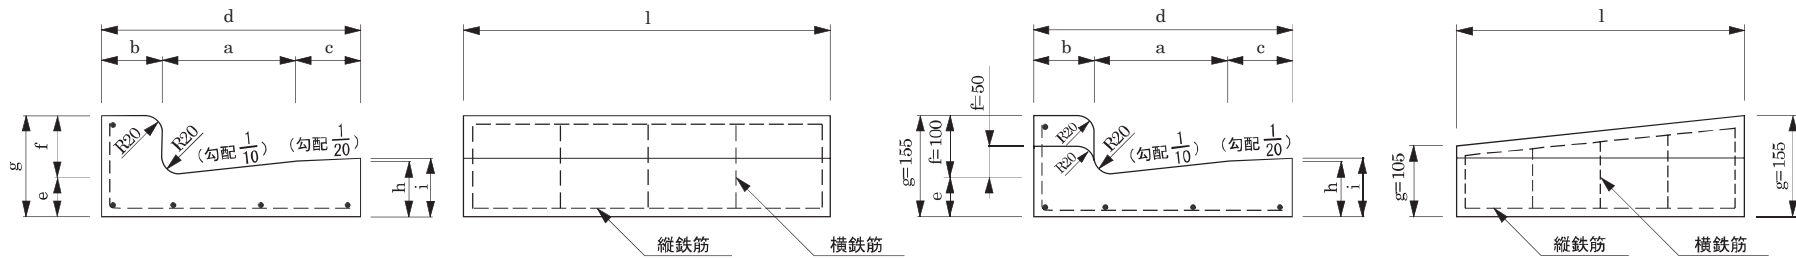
; コンクリートL形・鉄筋コンクリートL形
